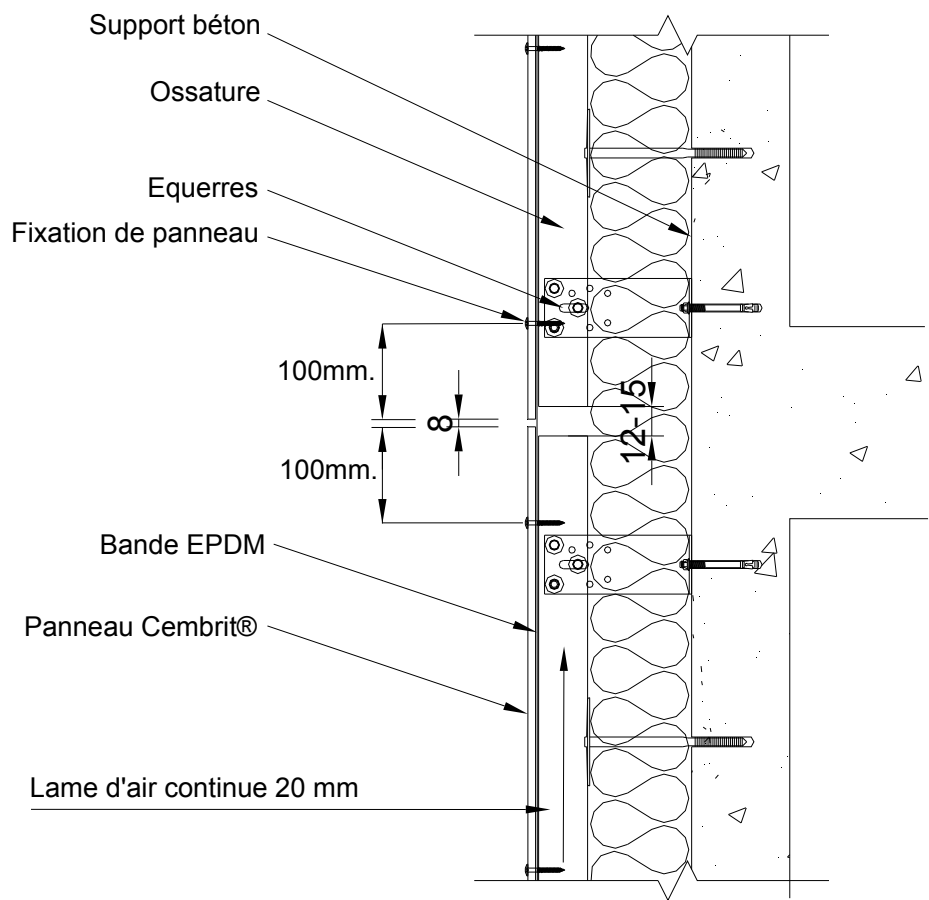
Joint de fractionnement au droit de chaque plancher - Coupe verticale
